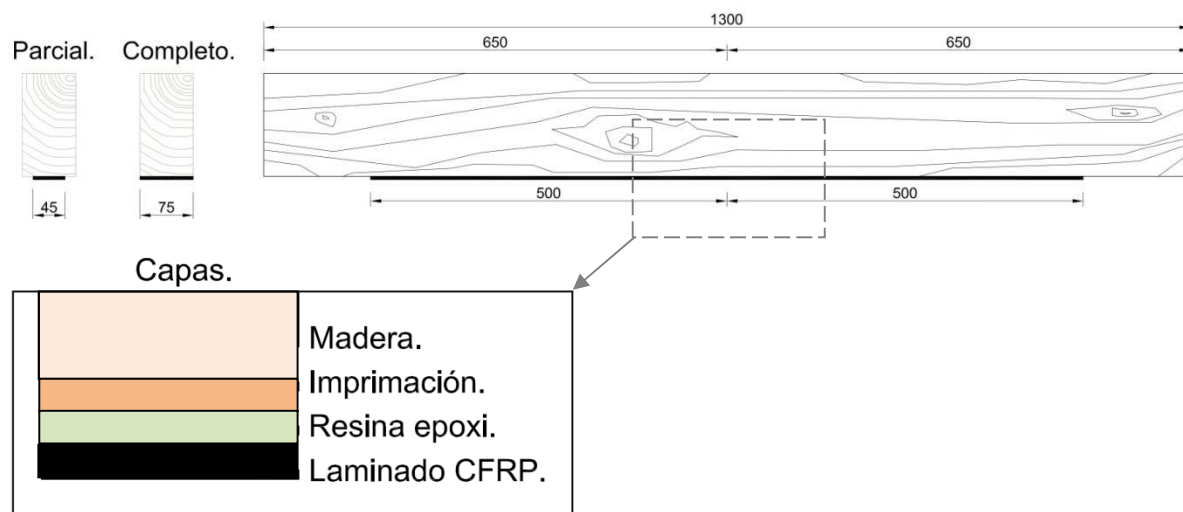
Disposición de los refuerzos con laminado inferior. (Medidas en milímetros).
